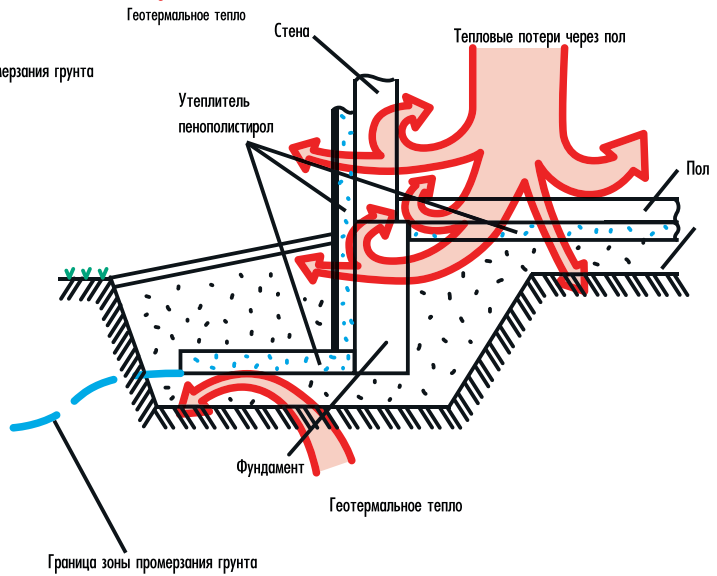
Тепловые потери через пол и фундамент малоэтажных зданий.
